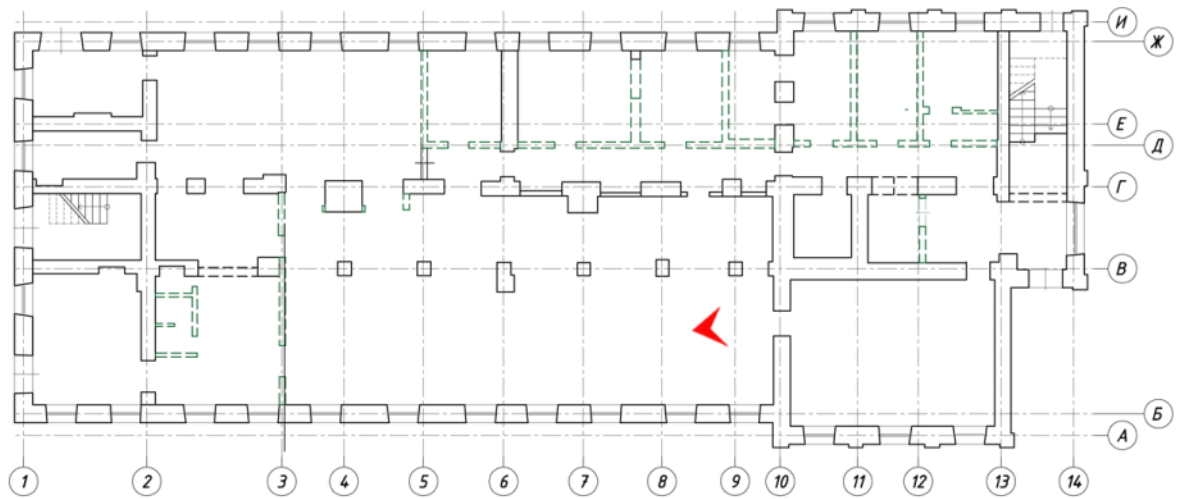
Стена по оси 10 в осях Б – В (первоначально – наружная).
